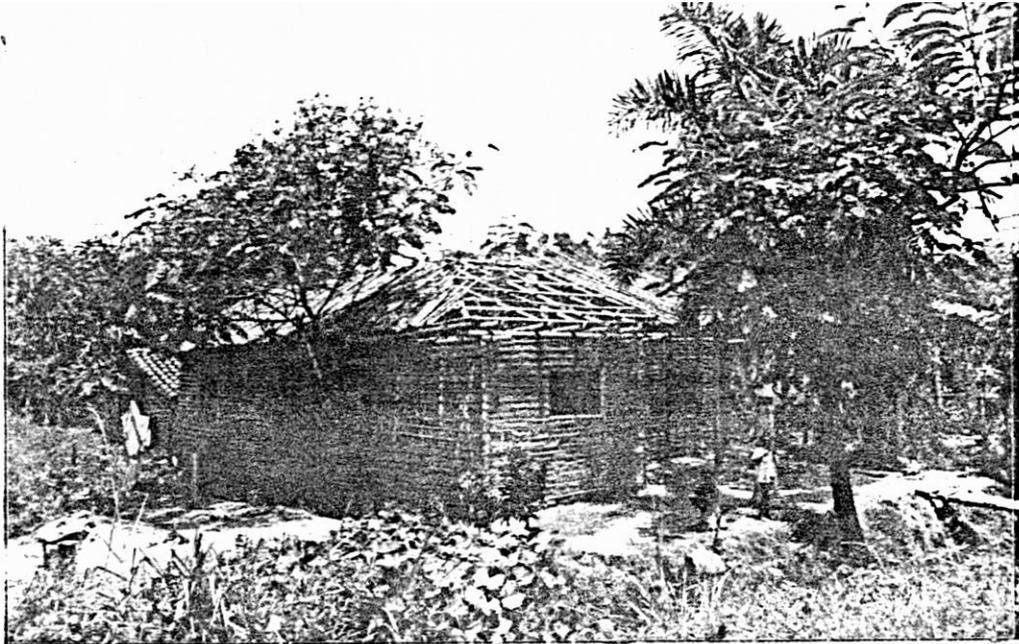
Vivienda rural de Puerto Tejada (Cauca)
